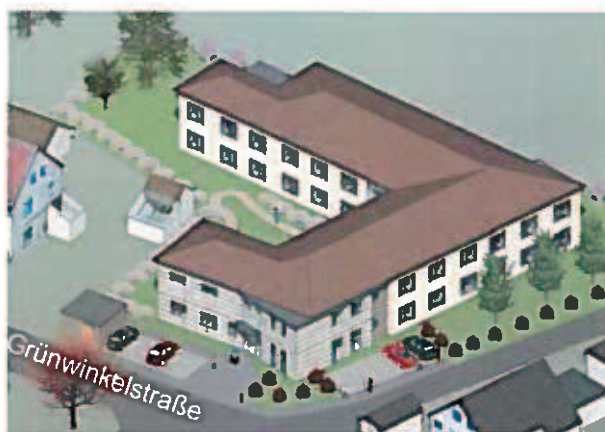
Isometrie des geplanten Pflegeheims; Blickrichtung von der Kreuzung Grünwinkelstraße / Nikolausstraße in Richtung Norden (Stand Vorentwurf 05/2017)
